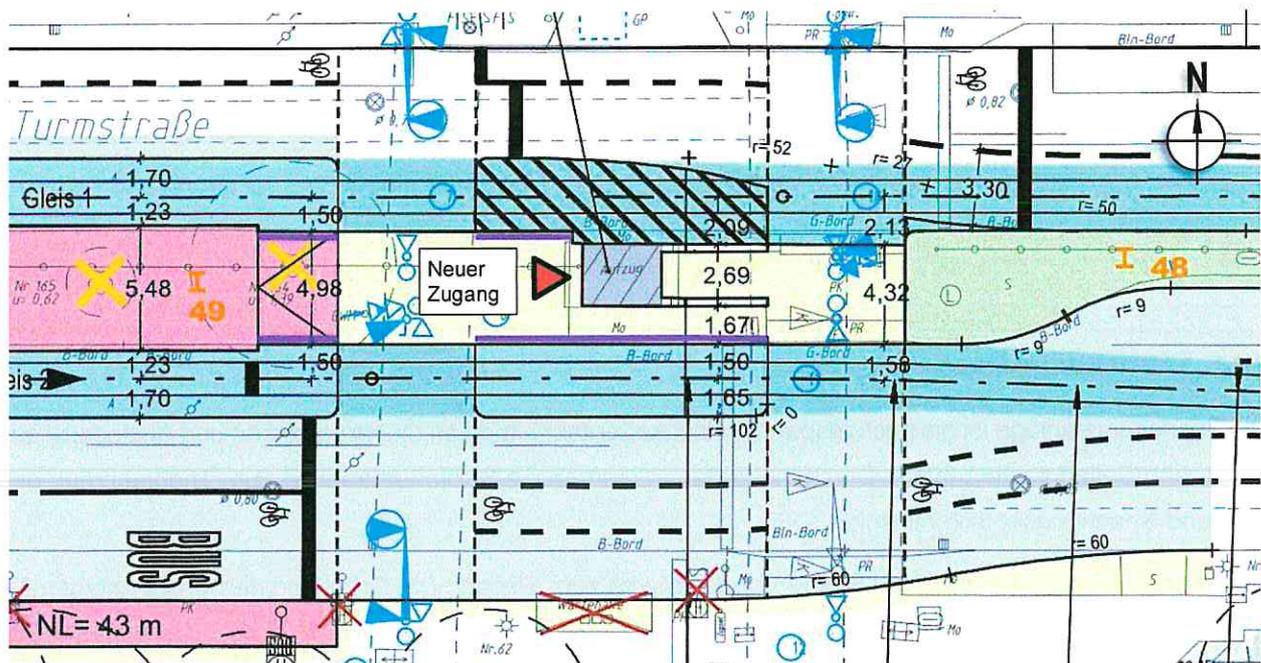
Lageplandetail Umbau des Aufzugs U-Bahnhof Turmstraße
